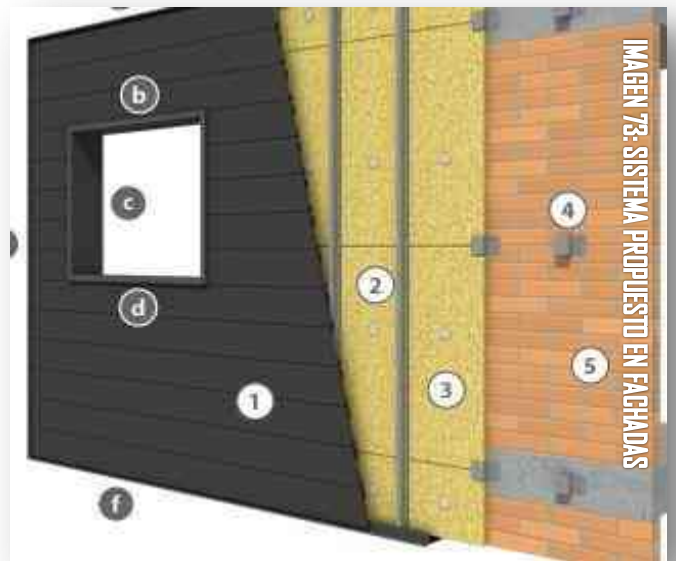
SISTEMA PROPUESTO EN FACHADAS
